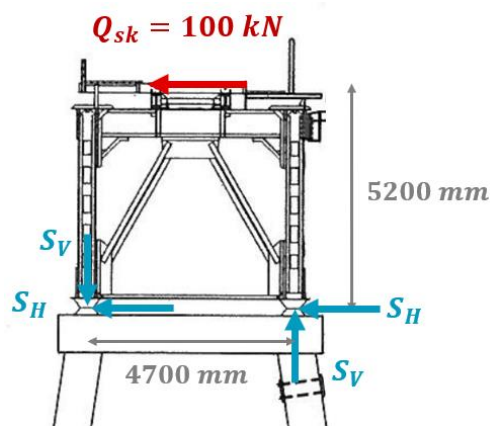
Lasttilfellet som gir størst belastning i pilar I
